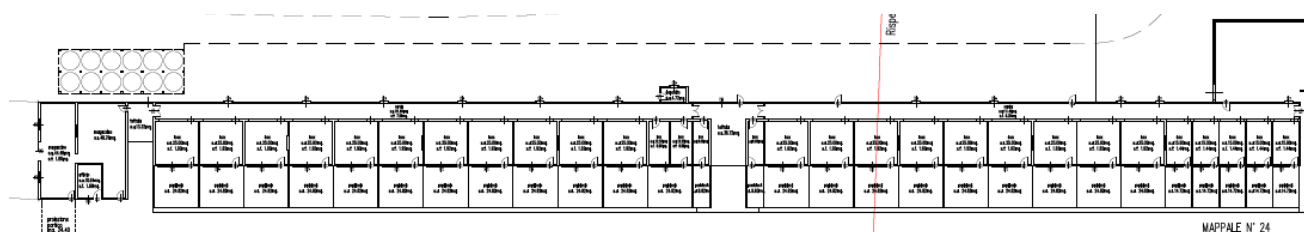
Planimetria e sezione della stalla vecchia lato Nord
